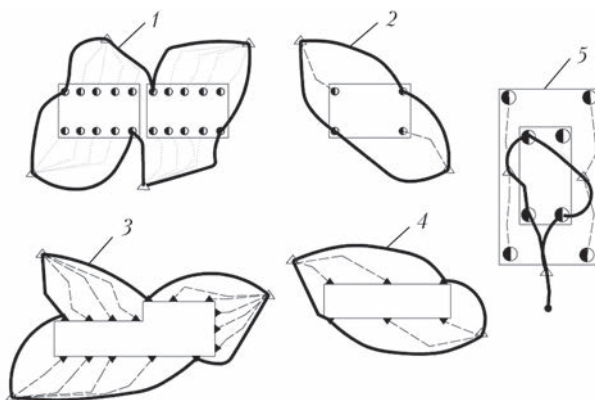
Схема нівелювання окремих агрегатів: 1 – установка охлаждения газа; 2 – установка очистки газа; 3 – службово-эксплуатационный и ремонтный блоки; 4 – склад запасных частей; 5 – турбоагрегати
